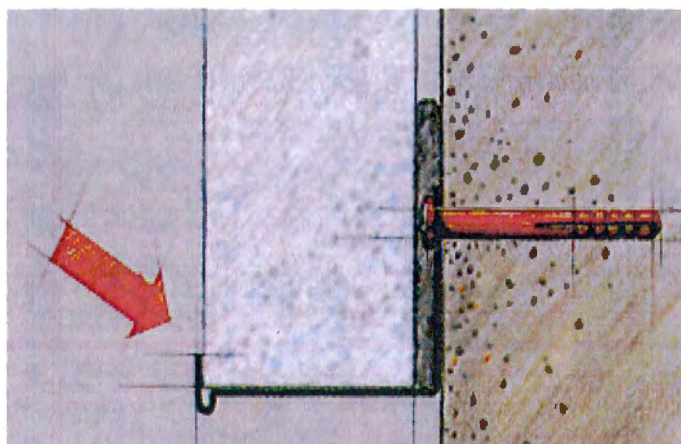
Примыкание цокольной планки и теплоизоляционной плиты
